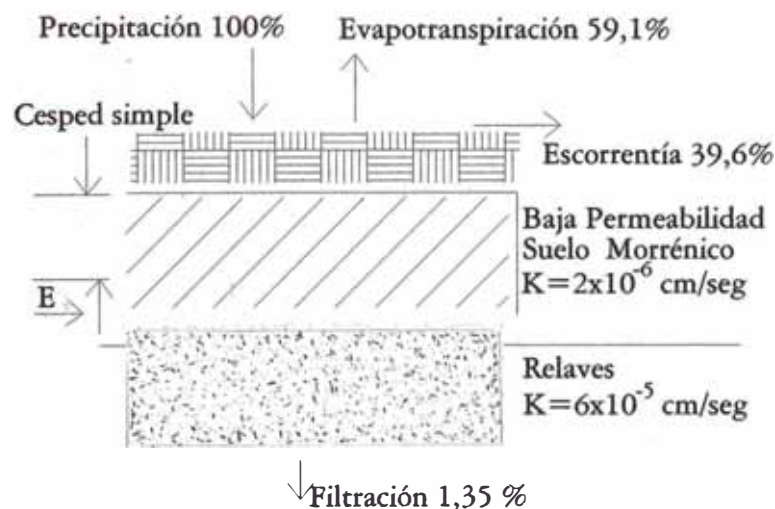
CUBIERTA MORRENICA DE BAJA PERMEABILIDAD
